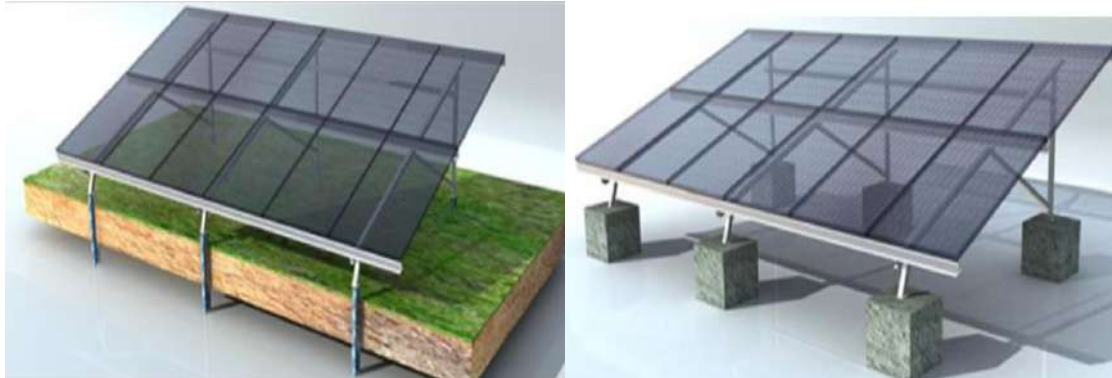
Instalación de estructura fotovoltaica en suelo: Hincada con postes y cimentación con hormigón
